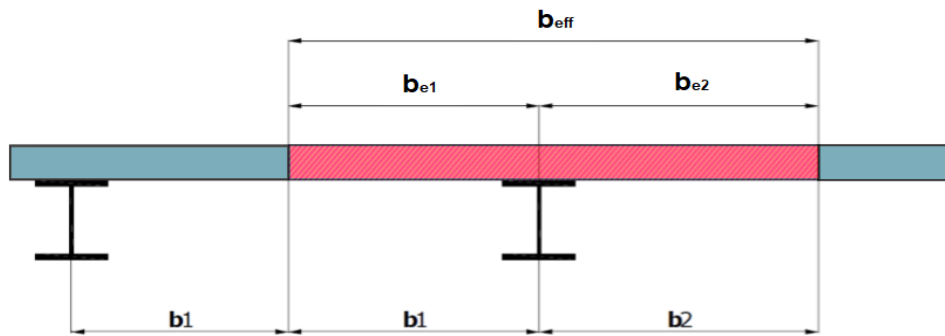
Largeur participante de dalle pour une poutre de plancher
